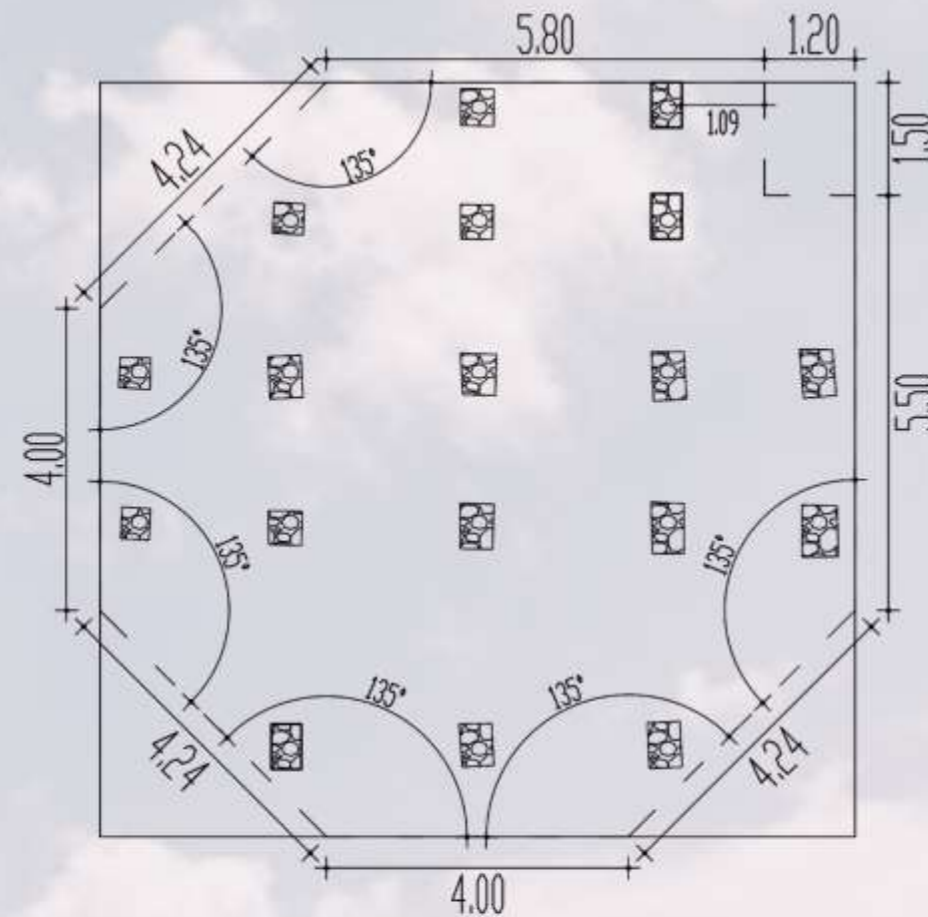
FIGURA DE LA PLANTA - ESPACIO P.A "7" N. +0.90
